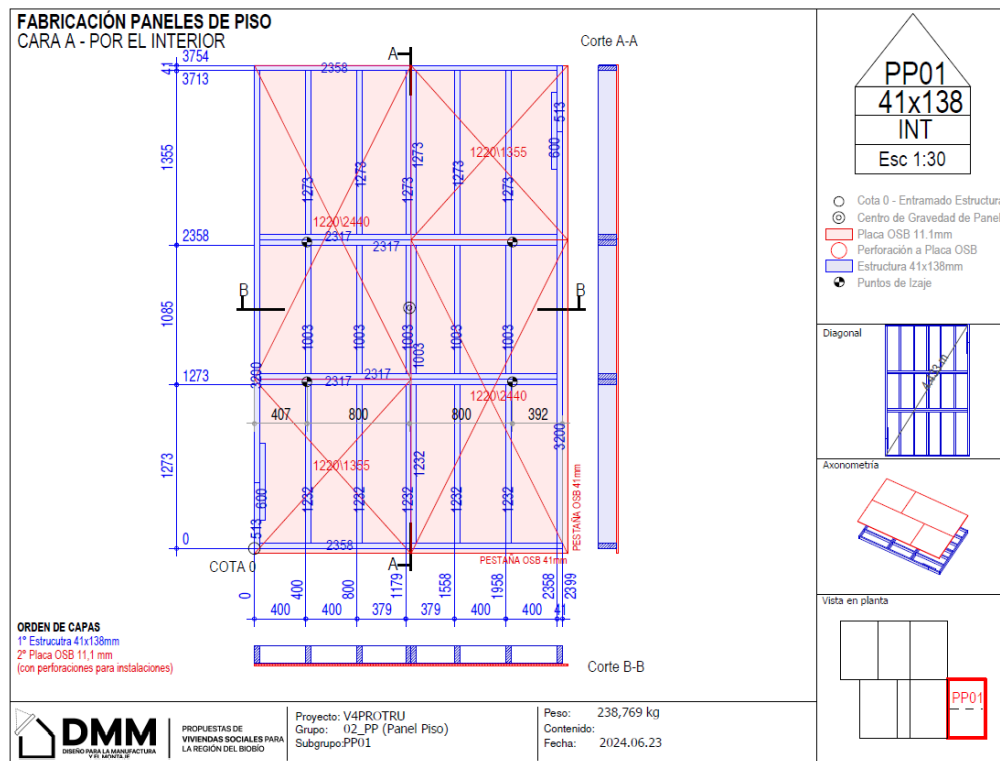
Plano de despiece panel PP01. Fuente: Proyecto 23BP-246692, generado en Cadwork (2024).
